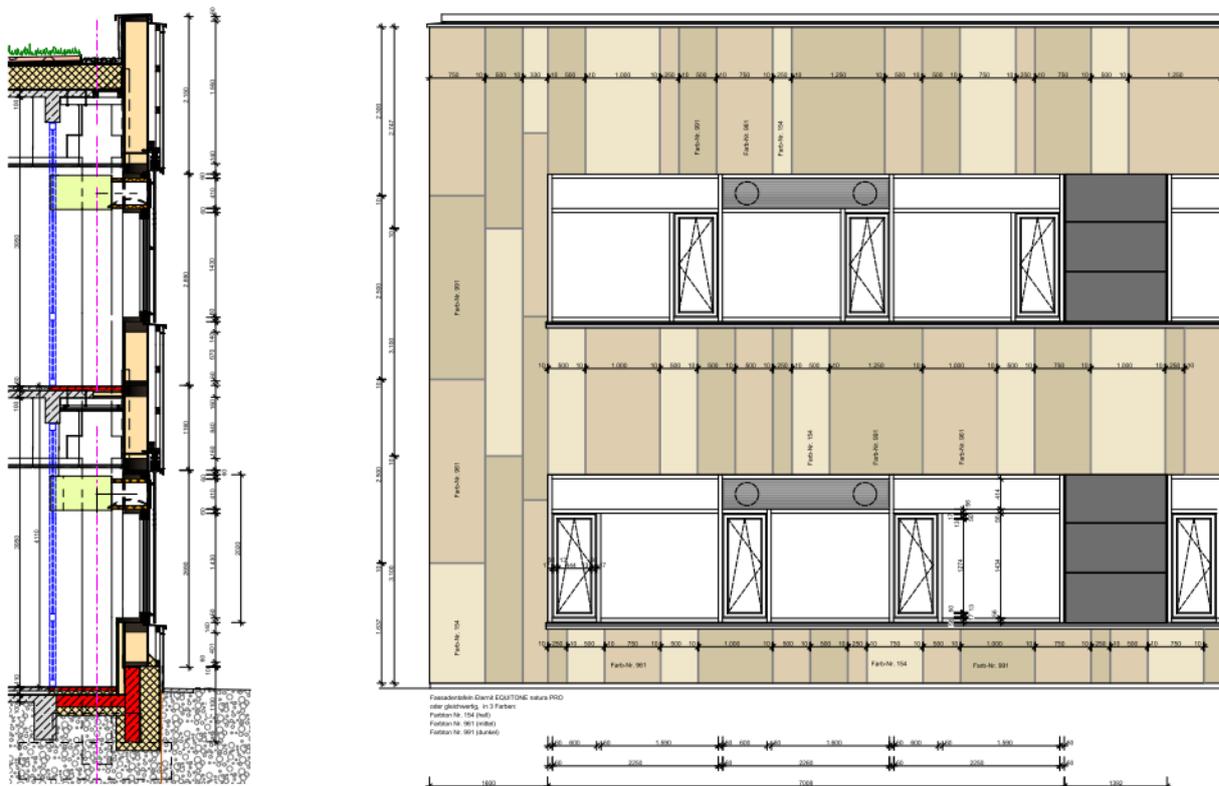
Fassadenschnitt (mit alter Fensterfassade) und Ansicht (Teilausschnitt)
